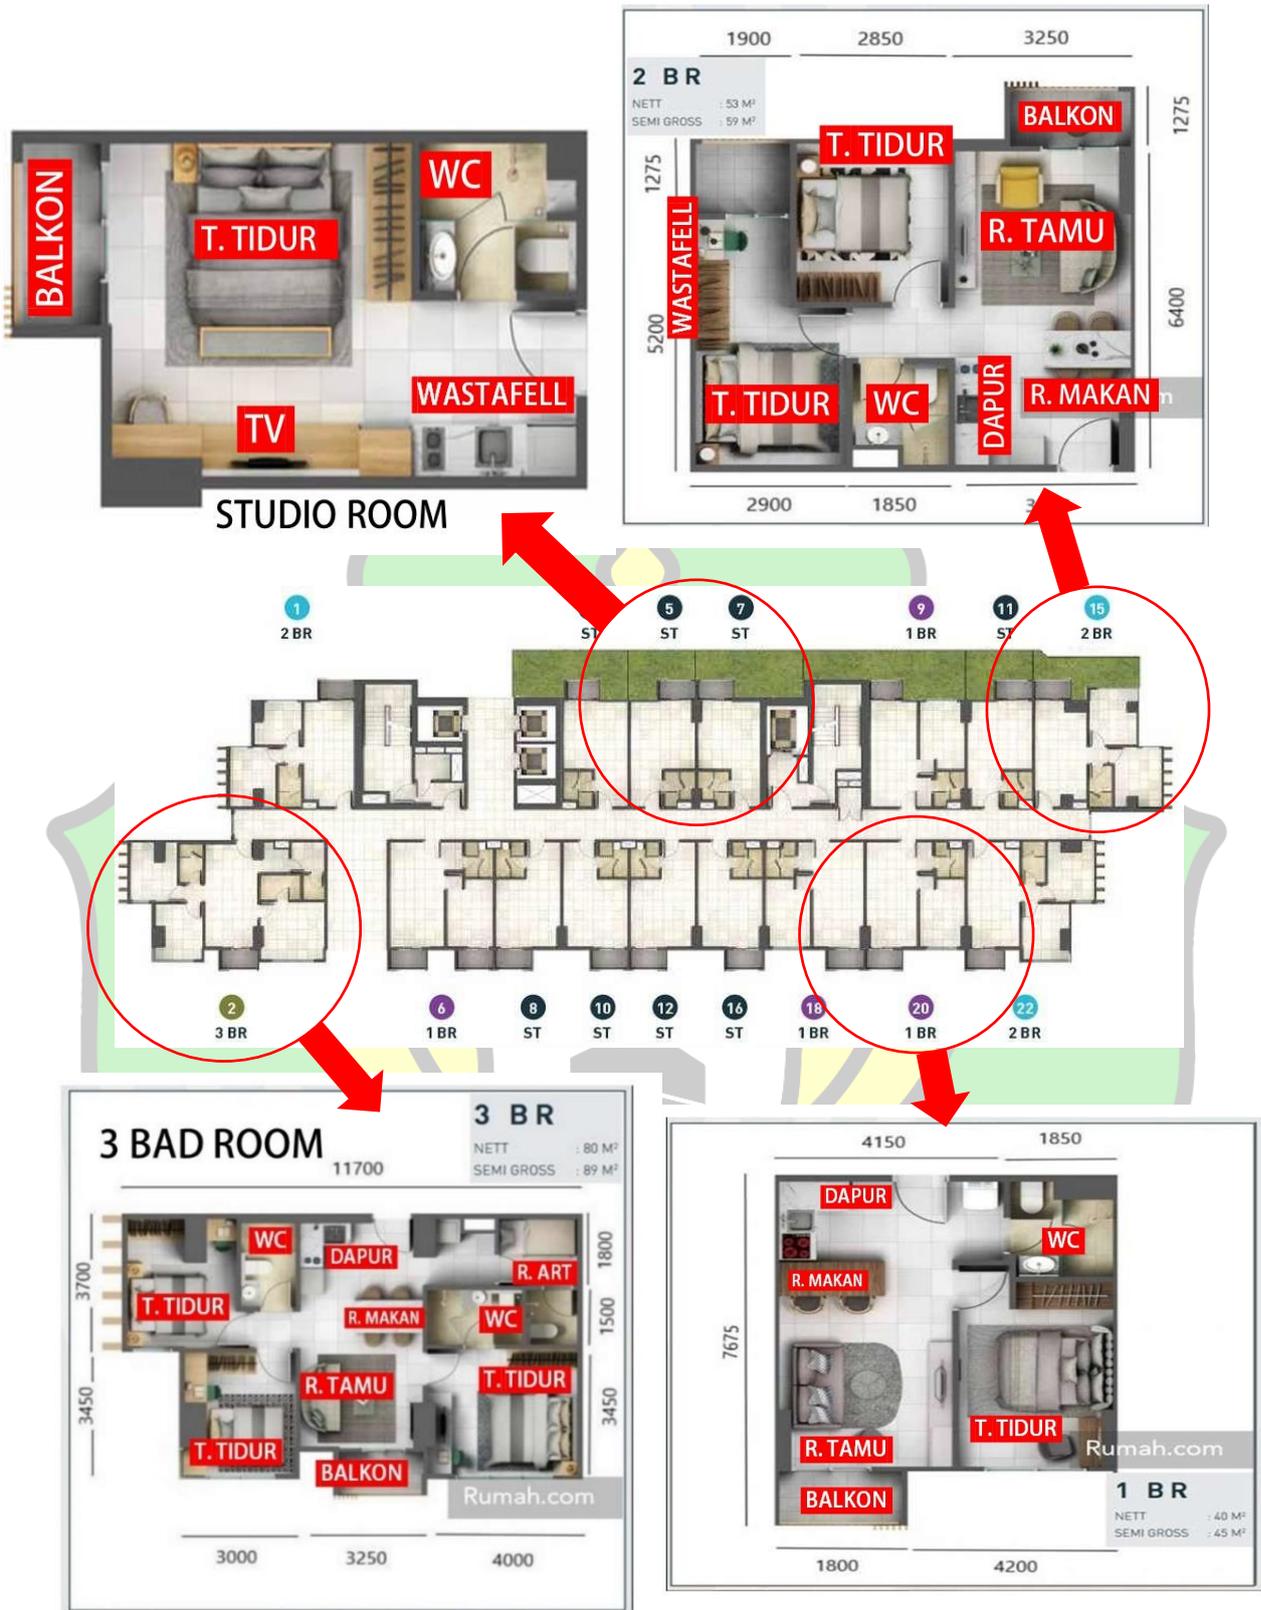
Site Plan Apartemen Cleon Park
